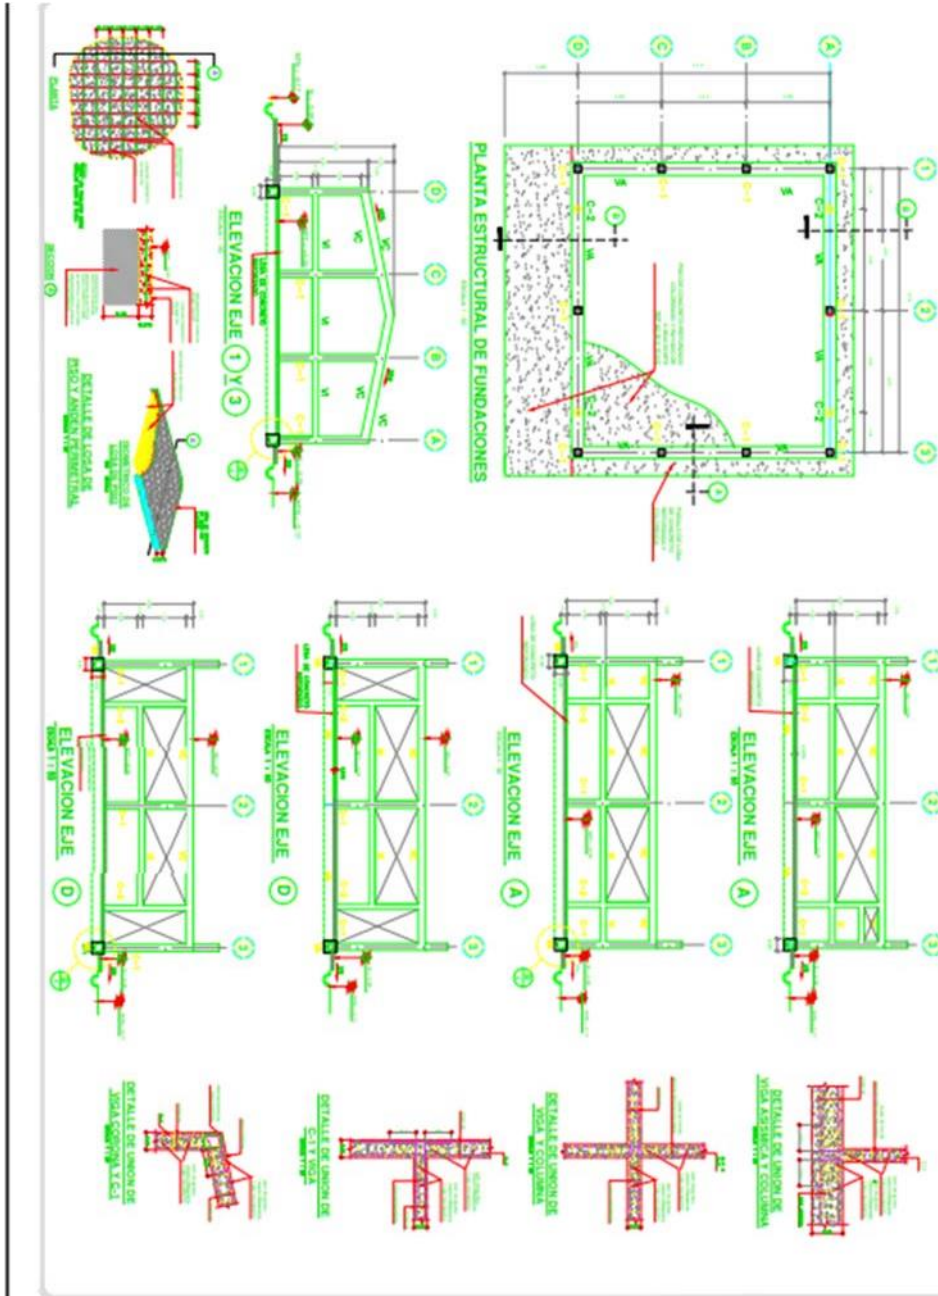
Planta estructural de fundaciones sector biblioteca
